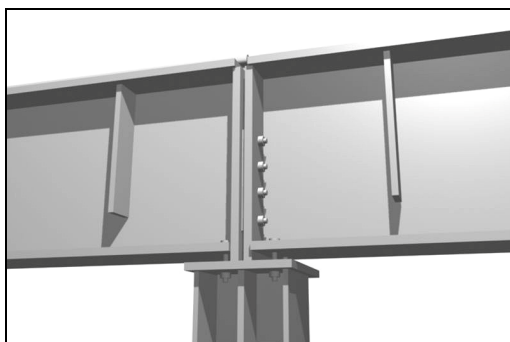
Опираие разрезных подкрановых балок на стальные колонны через опорное ребро
